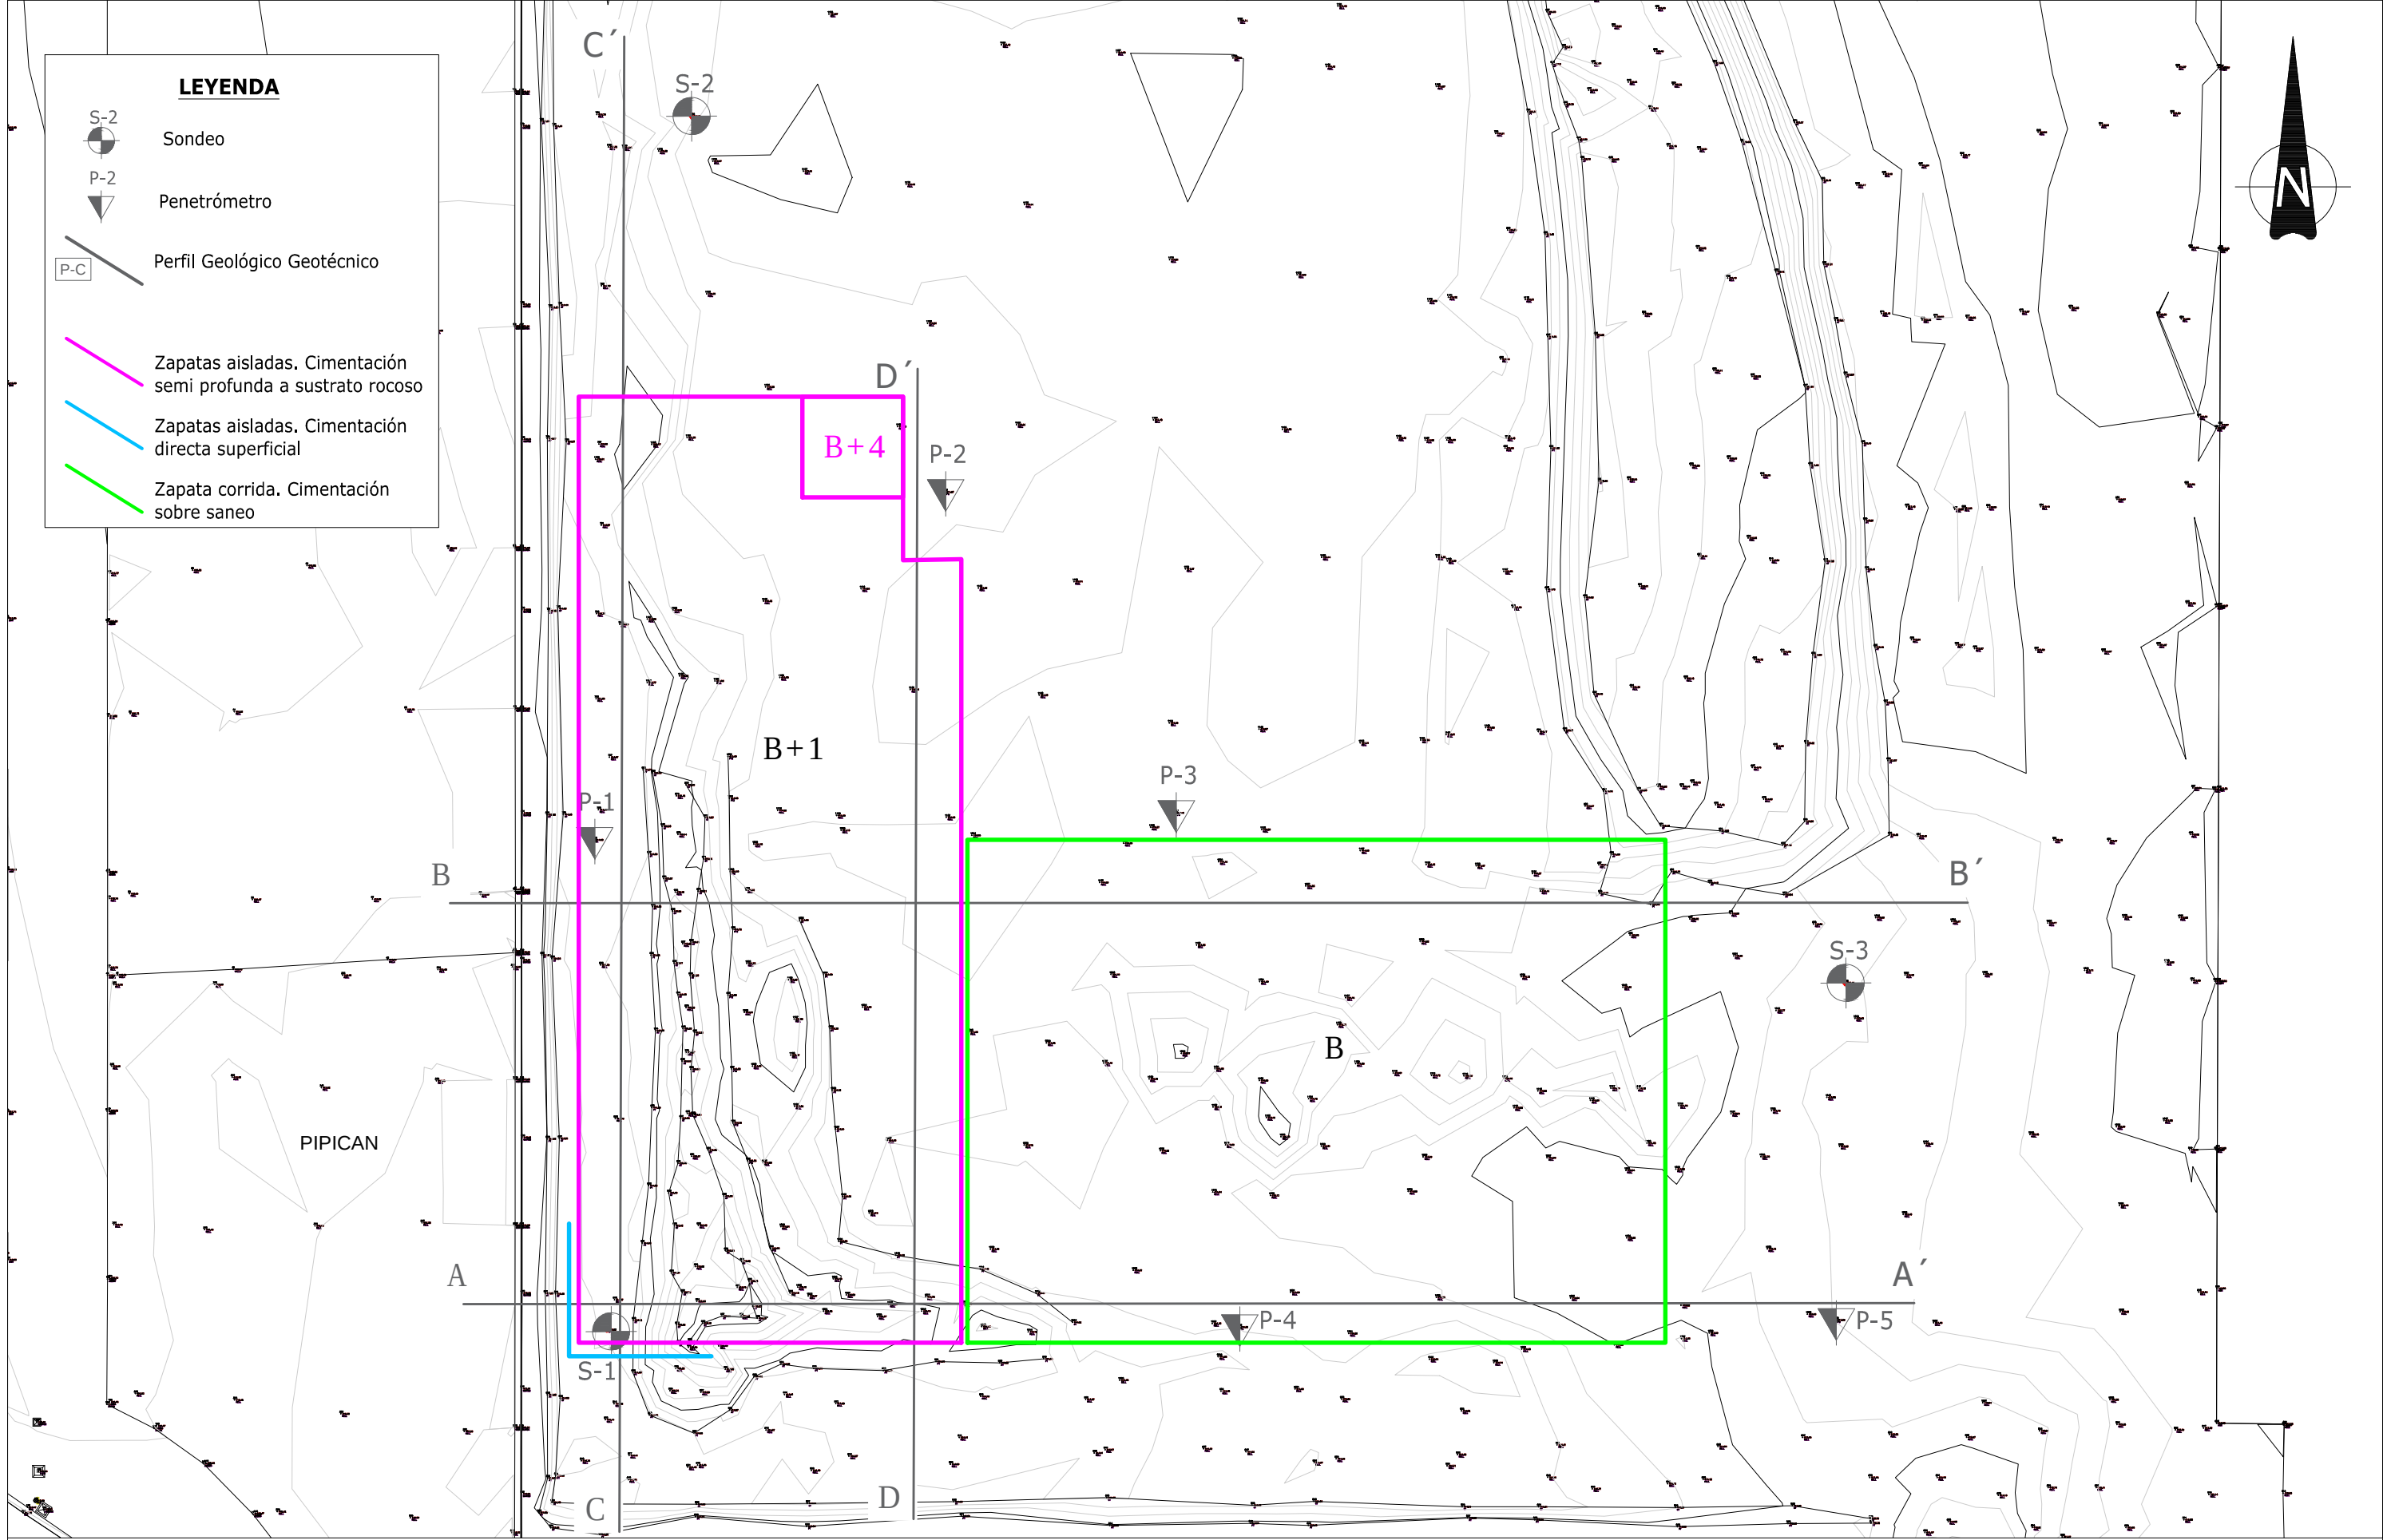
PLANTA DE CIMENTACIÓN PROPUESTA
